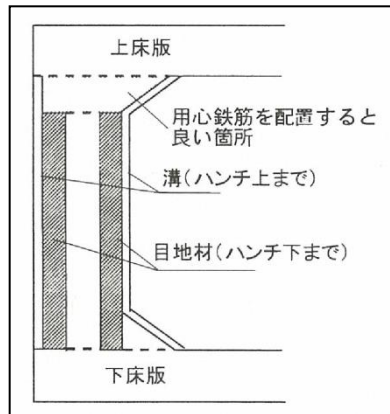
ボックスカルバートのひび割れ誘発目地の設置範囲例
